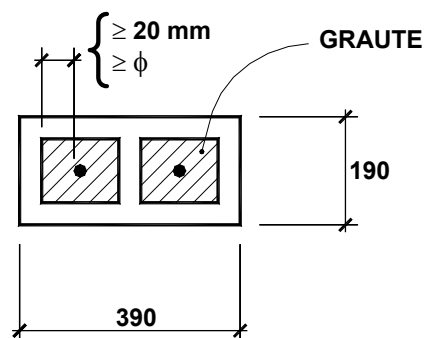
Cobrimento das armaduras protegidas por graute.
